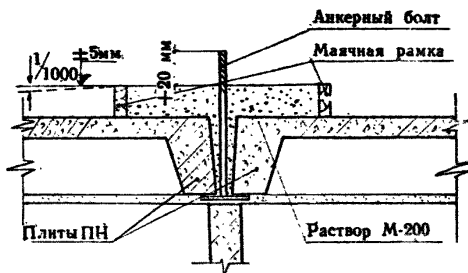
Устройство опорных мест под стойки каркаса надстройки рабочего здания
